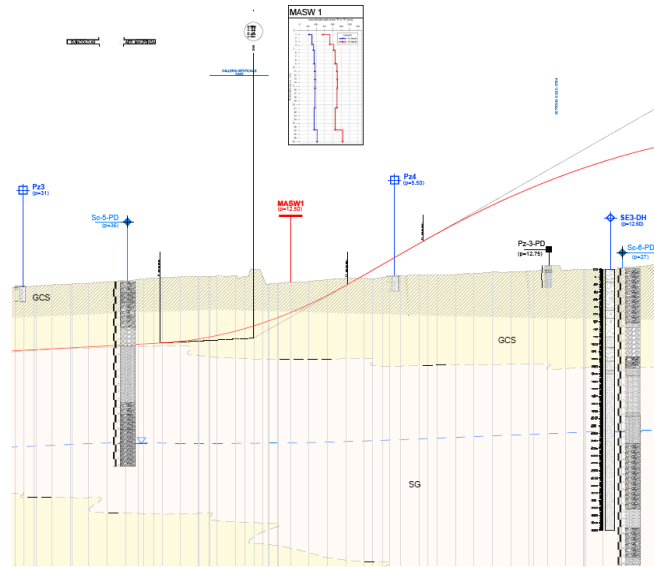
Stralcio profilo longitudinale 1° tratto
